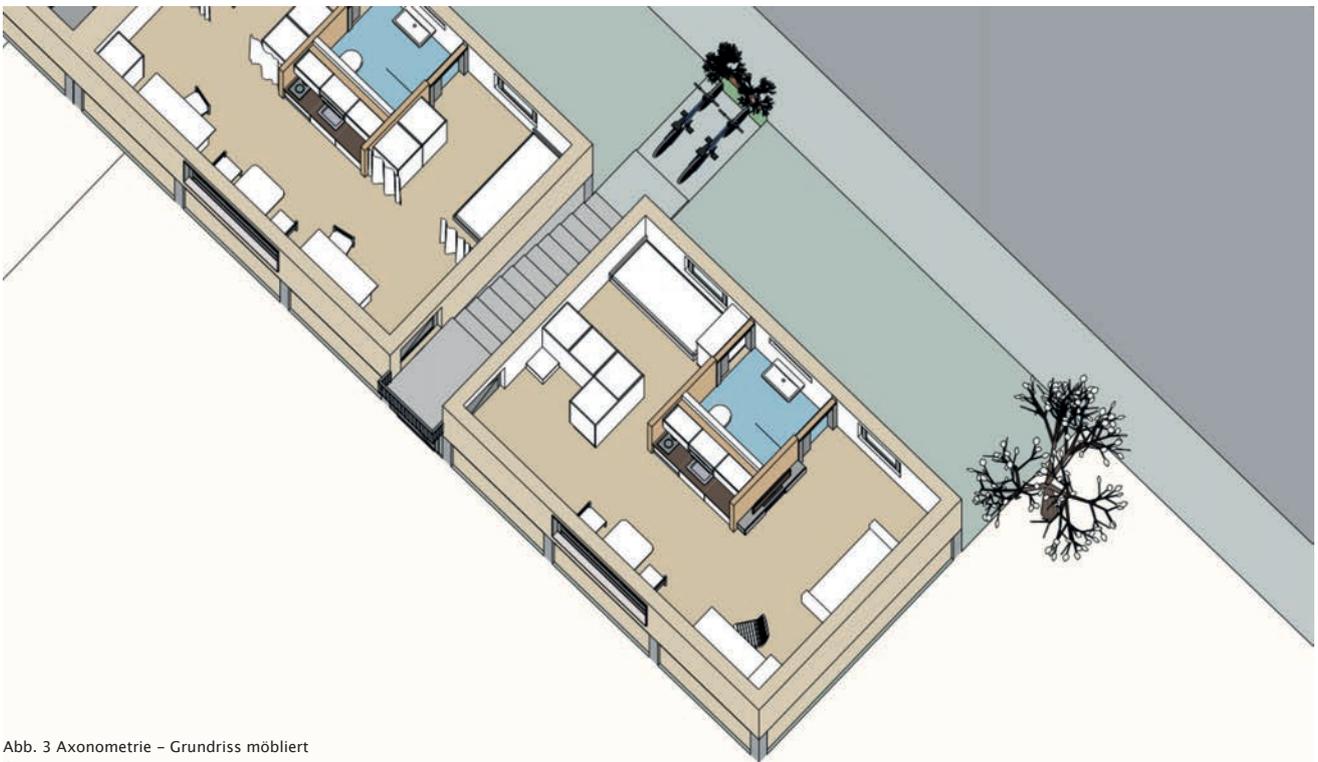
Axonometrie – Grundriss möbliert
